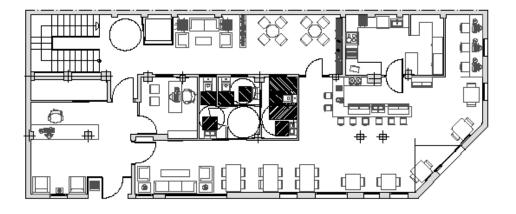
Plano de planta tercera propuesta. Elaboración propia
